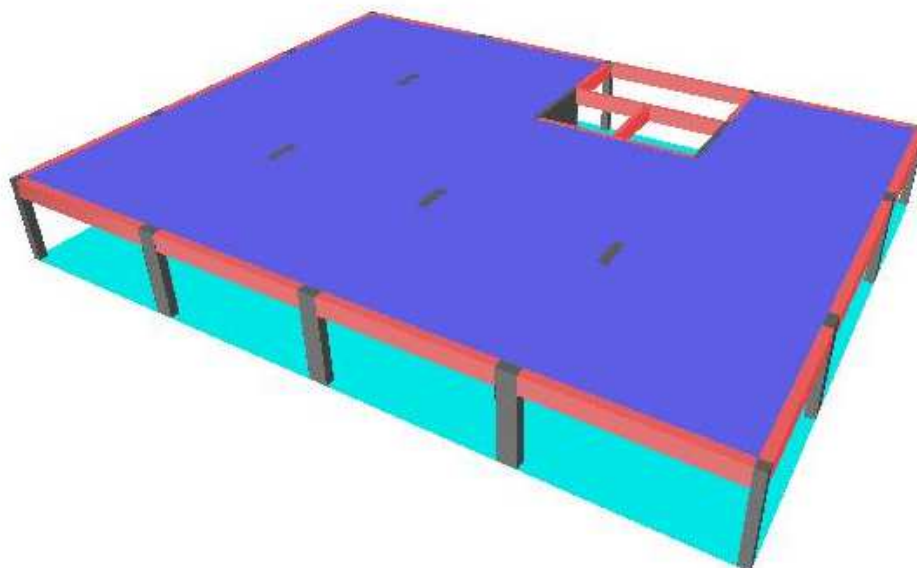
Estrutura do pavimento tipo em 3D via Eberick
